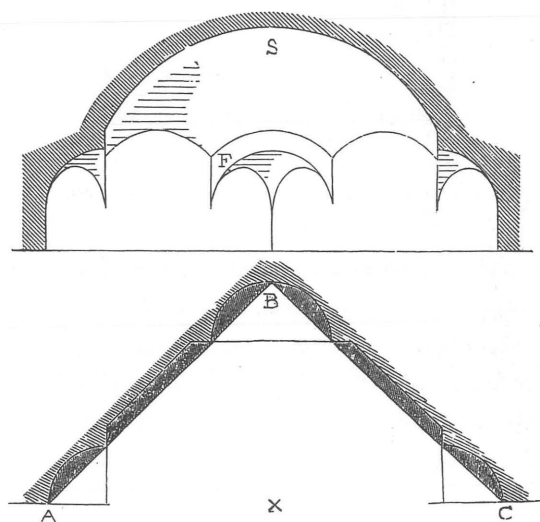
Planta y sección diagonal de una bóveda sentada sobre trompas
